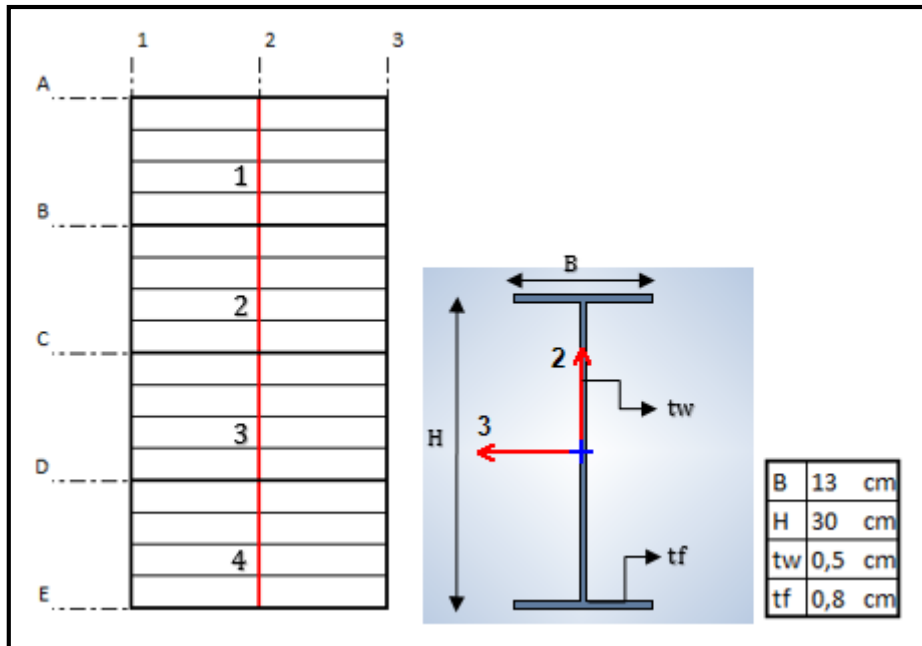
Dimensiones de vigas centrales en "Y" con pórticos arriostrados.
